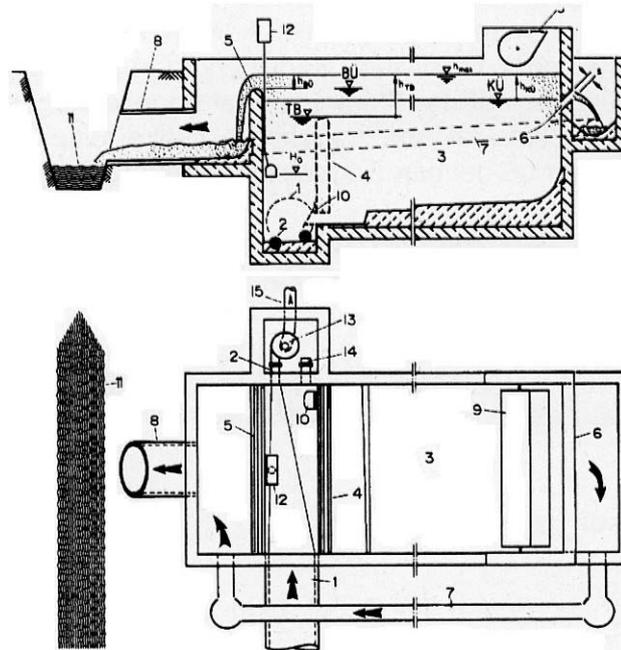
Regenüberlaufbecken im Schnitt und der Draufsicht, Durchlaufbecken im „unechten“ Nebenschluß“
